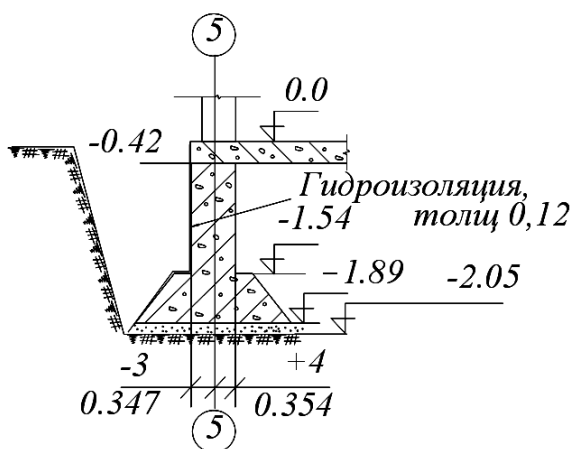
Фрагмент исполнительной схемы фундамента
